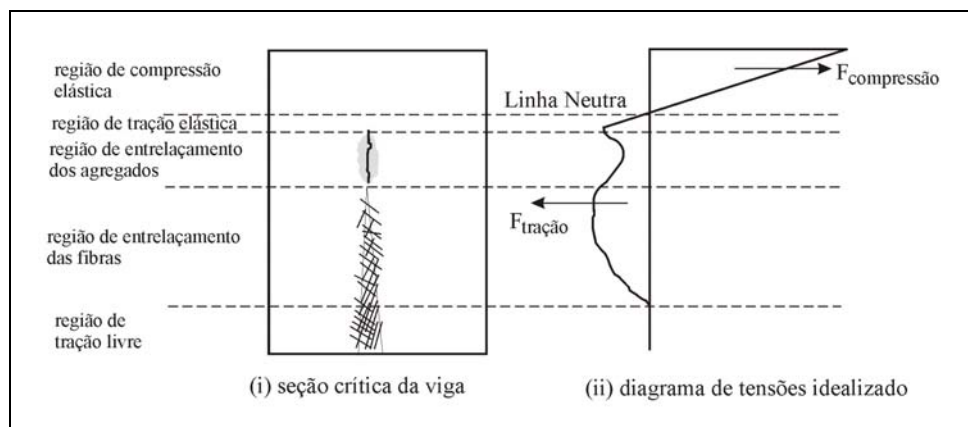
Representação esquemática da viga de concreto reforçado com fibras de aço sob o carregamento de flexão – Estágio 4: microfissura e arrancamento das fibras (JONES, 1998).
